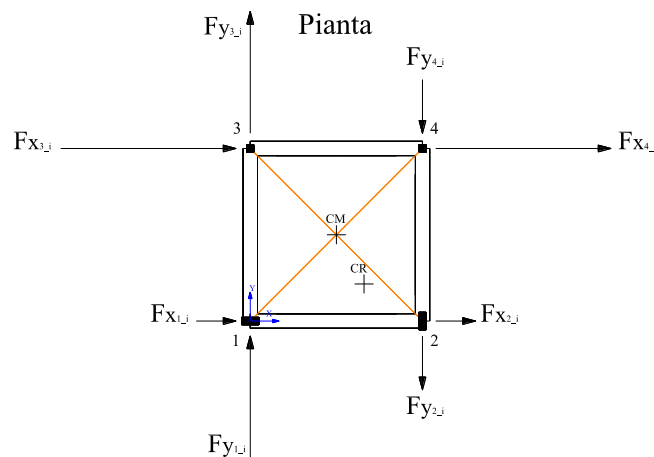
Sistema di forze proporzionali al modo fondamentale in direzione x , per una struttura con elevata eccentricità bi-direzionale fra C_R e C_M .
